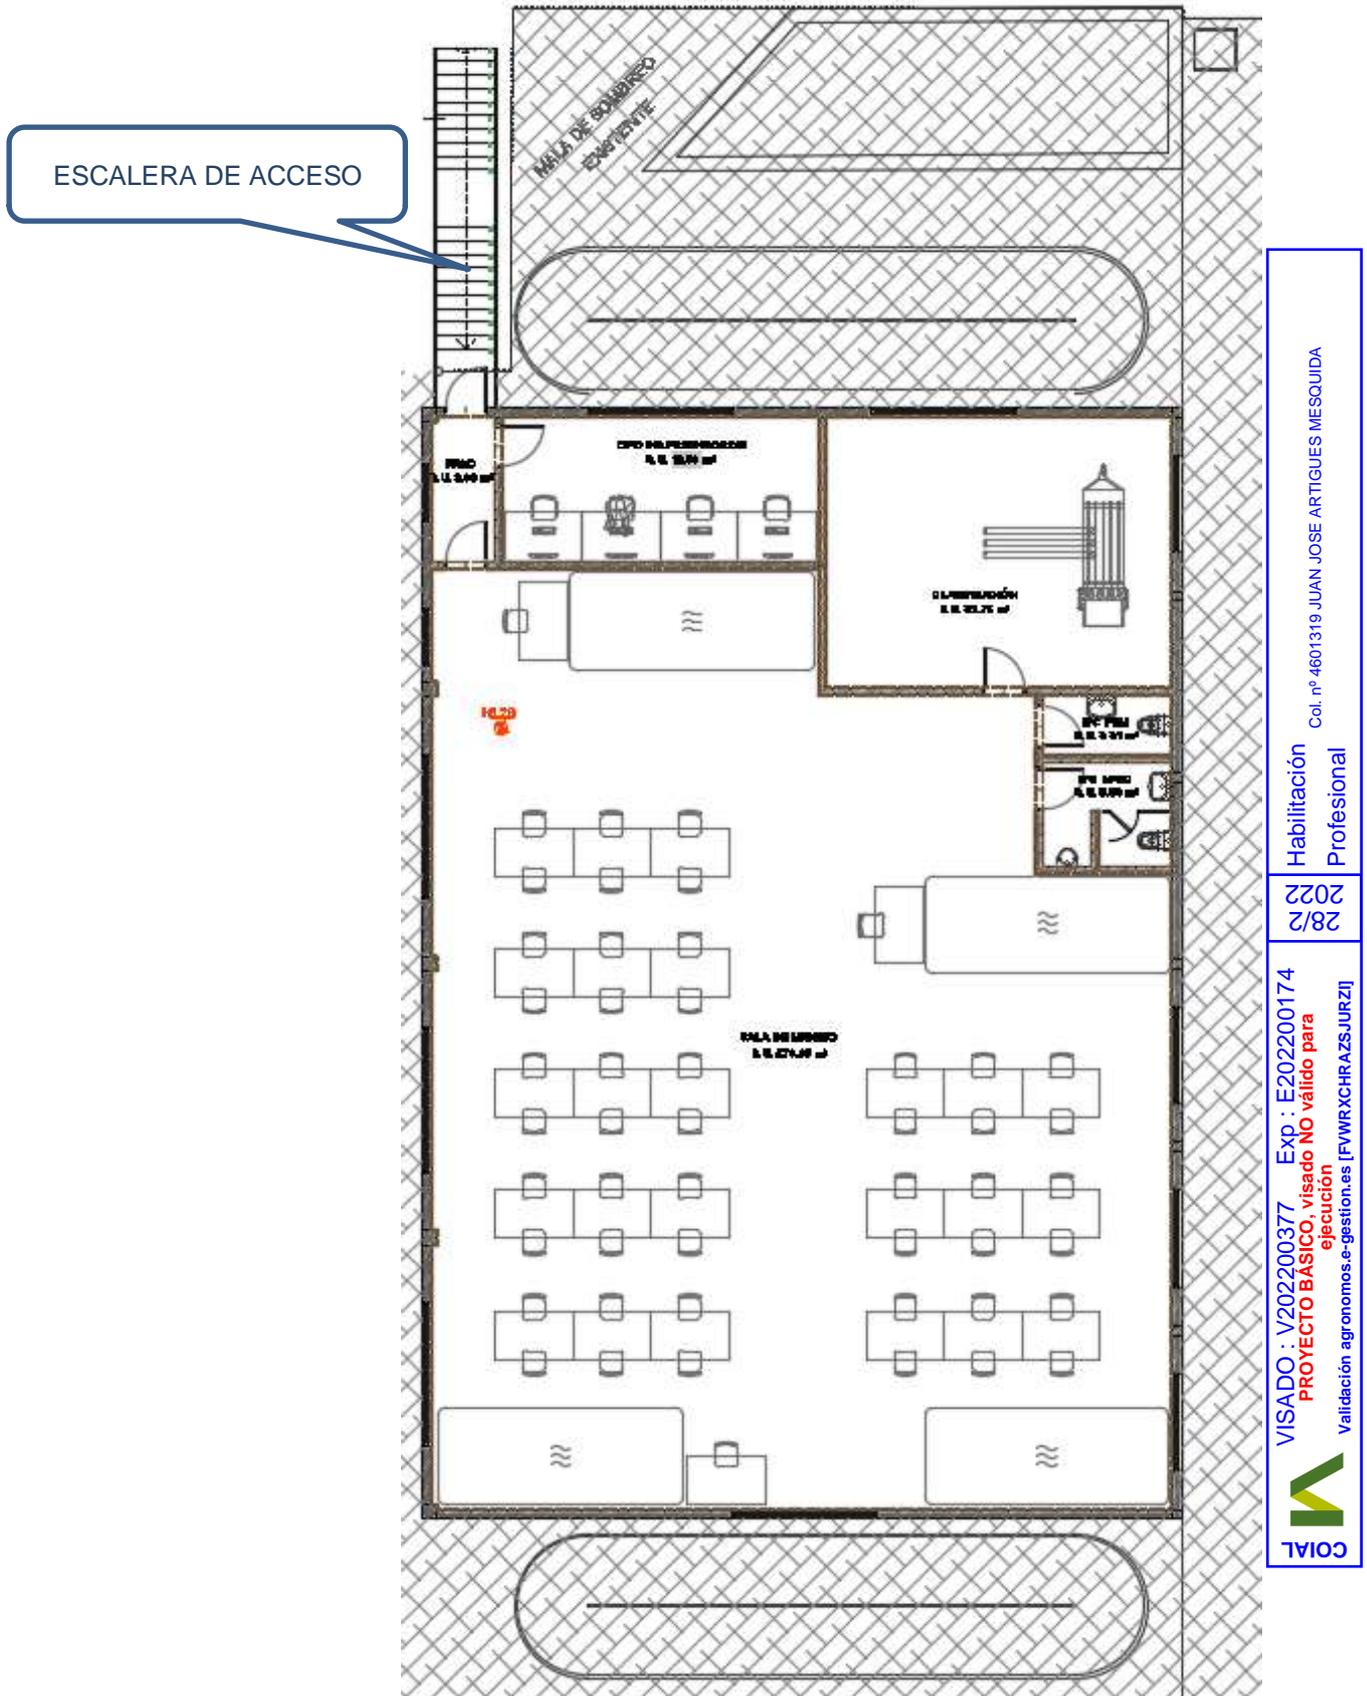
Nueva planta piso sobre pre-engerde existente y escalera de acceso
